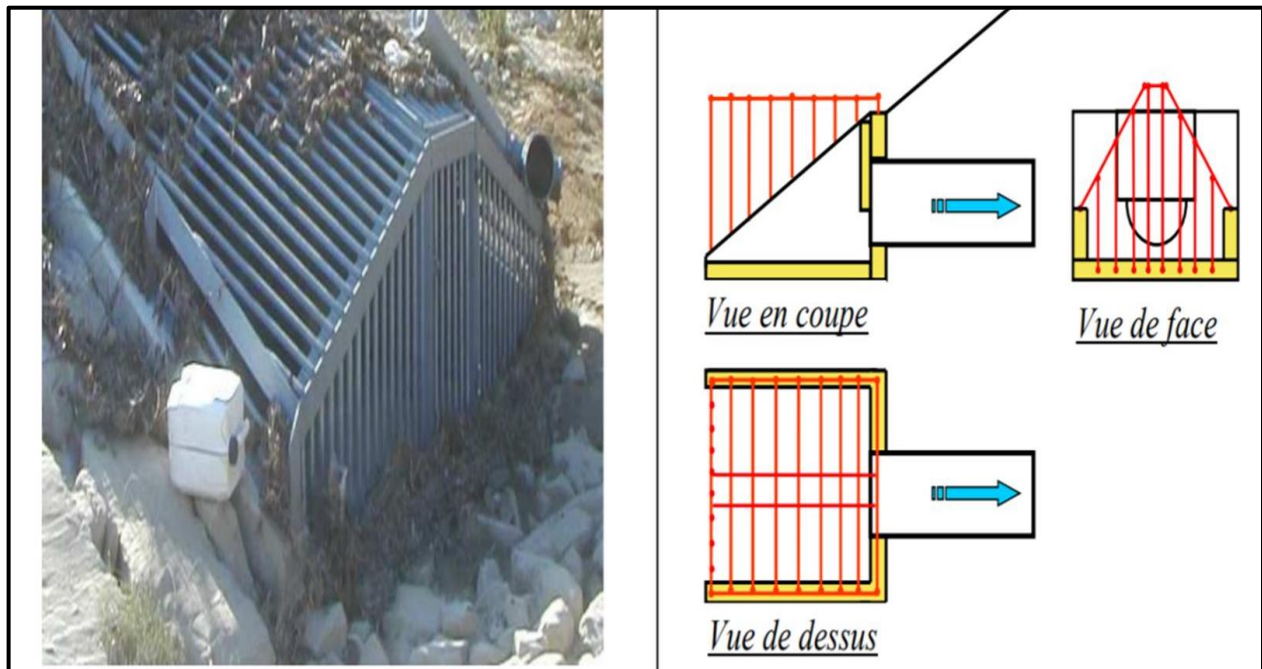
Exemple et schémas de principe d'un dispositif anti-embâcles à l'amont d'une conduite fond
